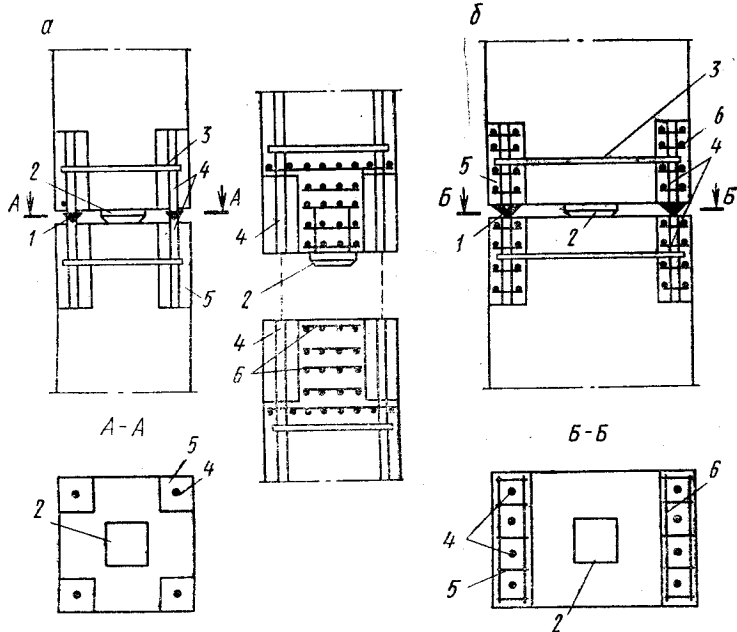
Конструкция жесткого стыка колонн с ванной сваркой арматурных выпусков
